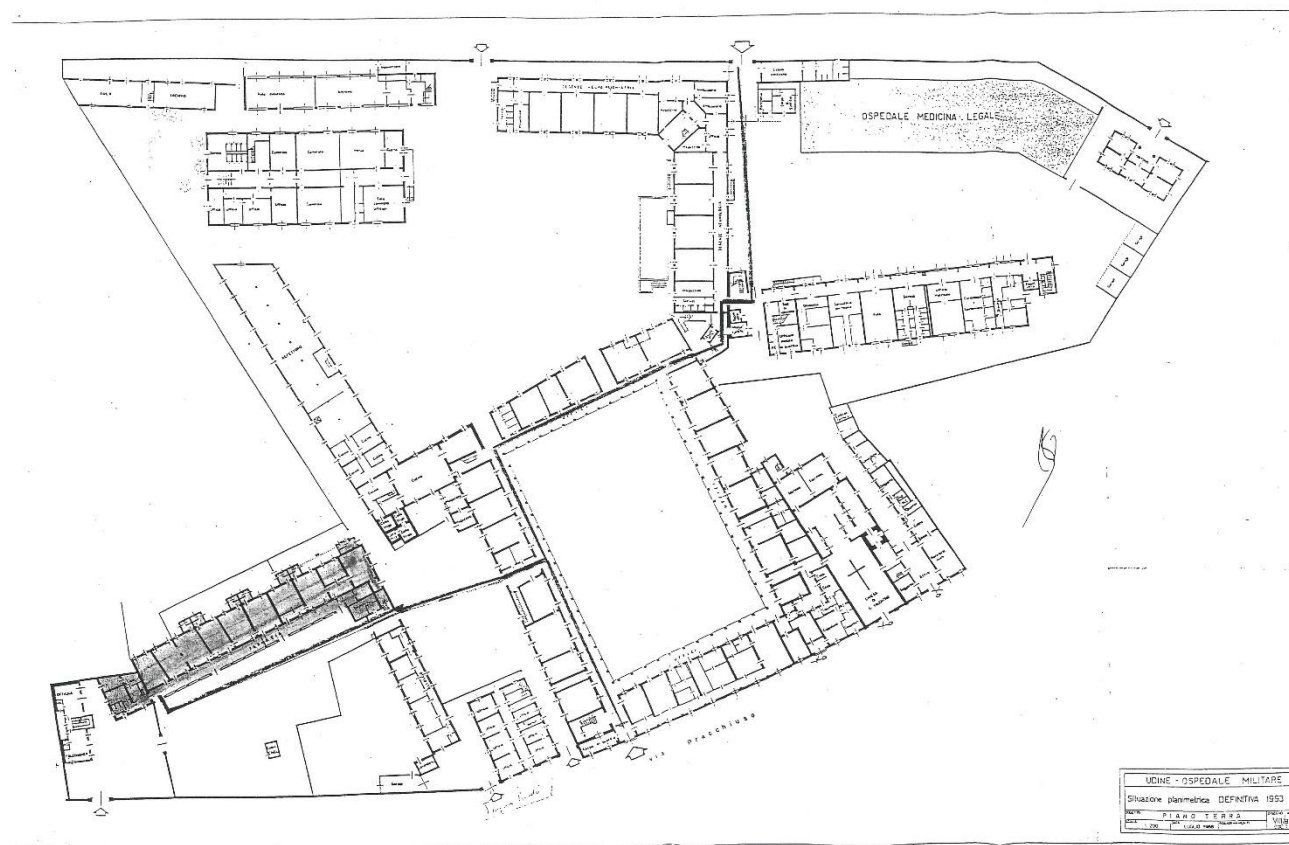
Planimetria storica generale del complesso Ex Caserma Reginato - Ospedale militare (stato rilevato del 1993)
